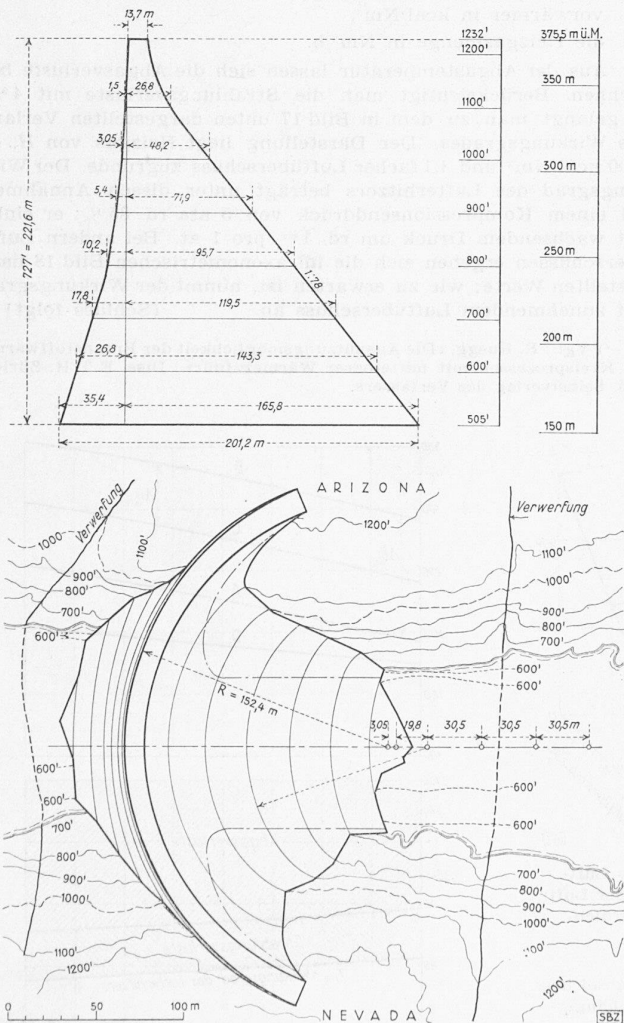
Boulder-Dam. Oben: Querschnitt an der tiefsten Stelle. Unten: Grundriss, Masstab 1:4000
